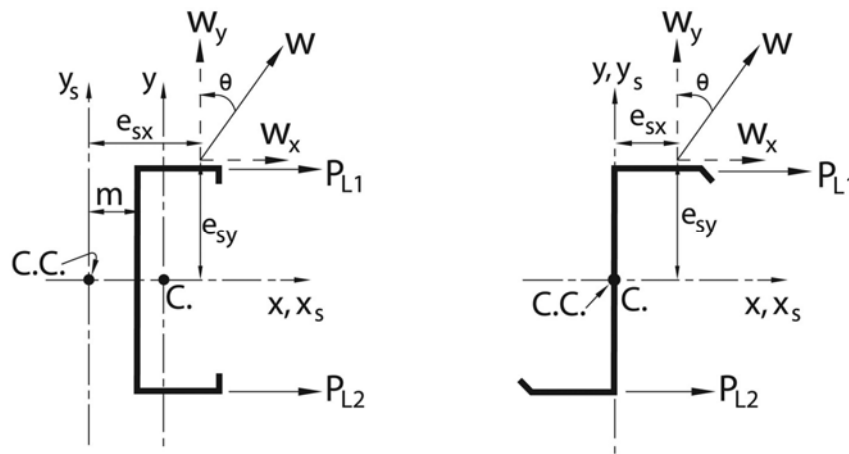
Sistema de coordenadas y direcciones positivas de las fuerzas
